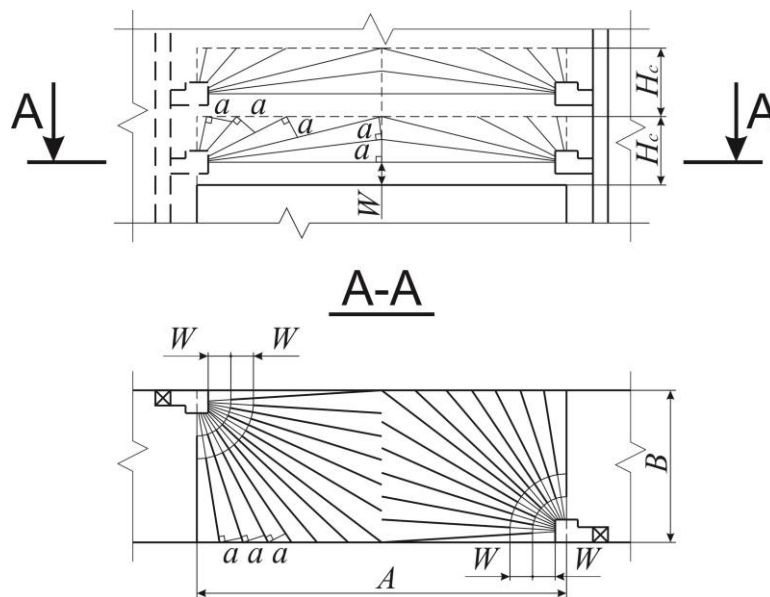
Розрахункова схема віялово-пучкового розташування свердловин
